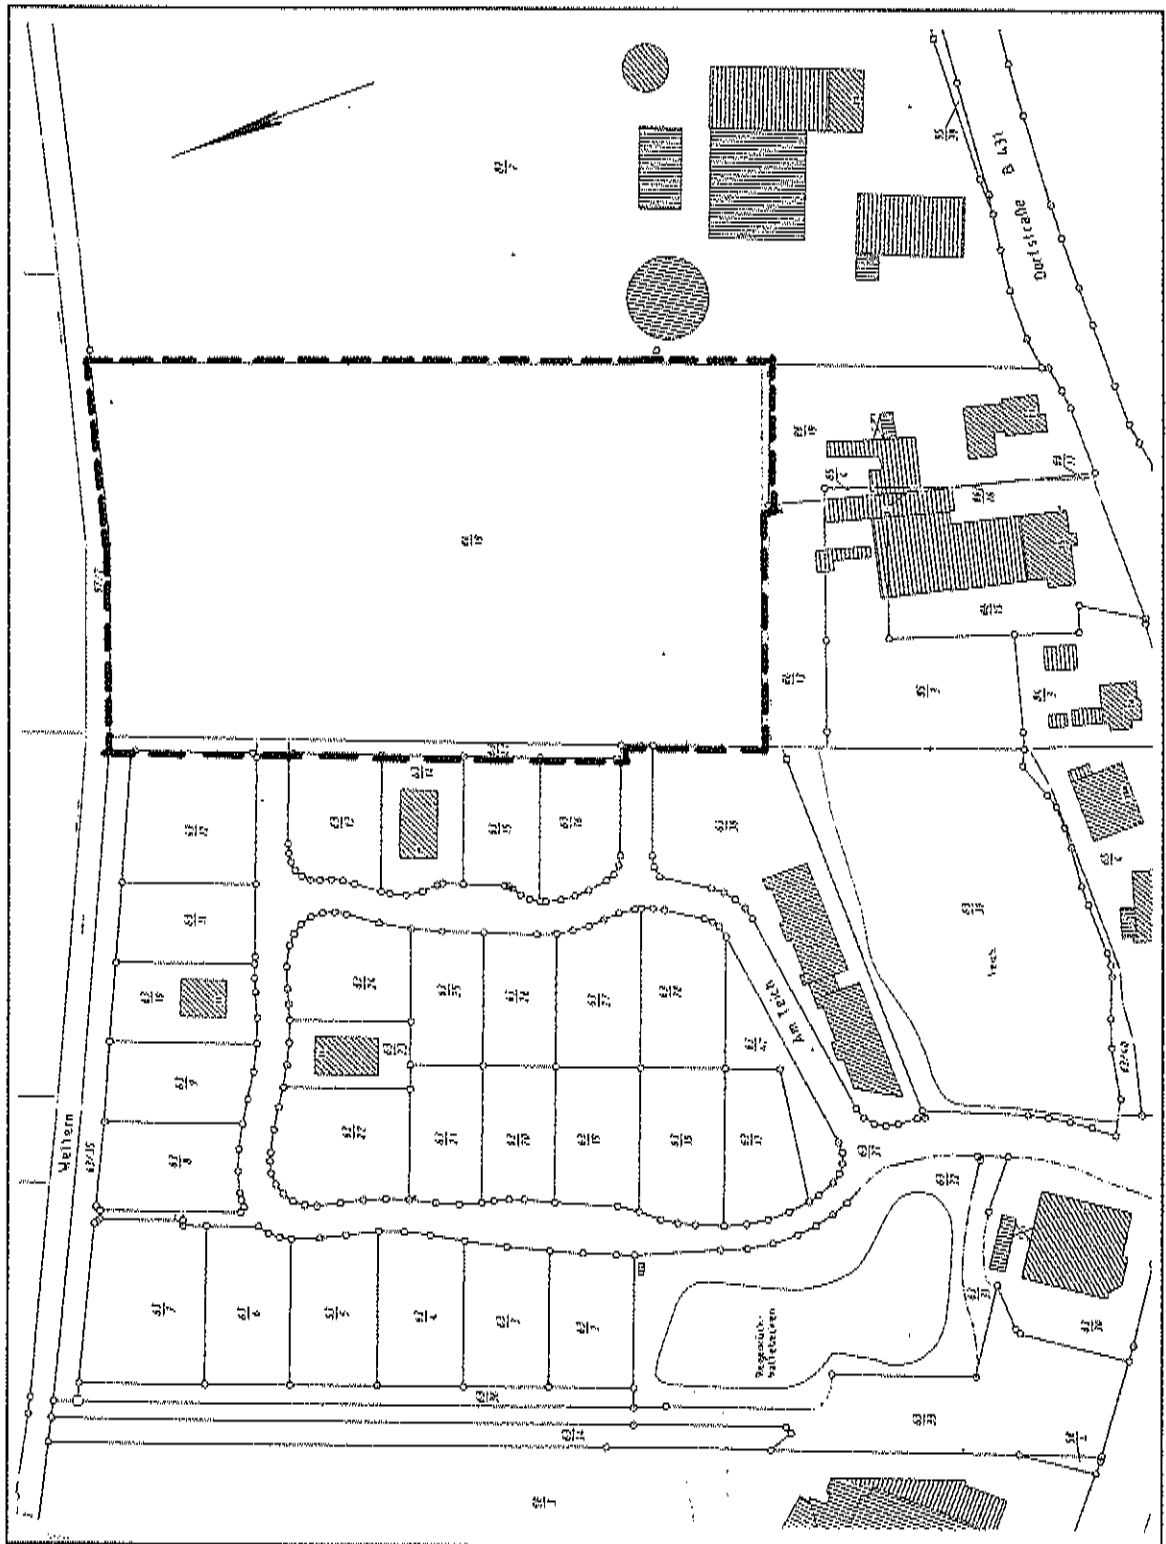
Plangebiet und räumliche Gebietsabgrenzung auf Grundlage eines Lage- und Höhenplanes vom 19.08.1998, unmaßstäblich
